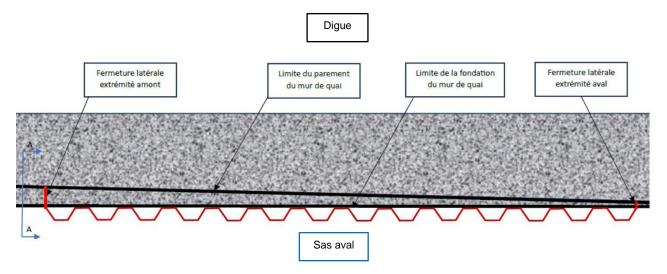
Schéma de principe du rideau de palplanches et de ses fermetures latérales – vue en plan (Source : EDF)
